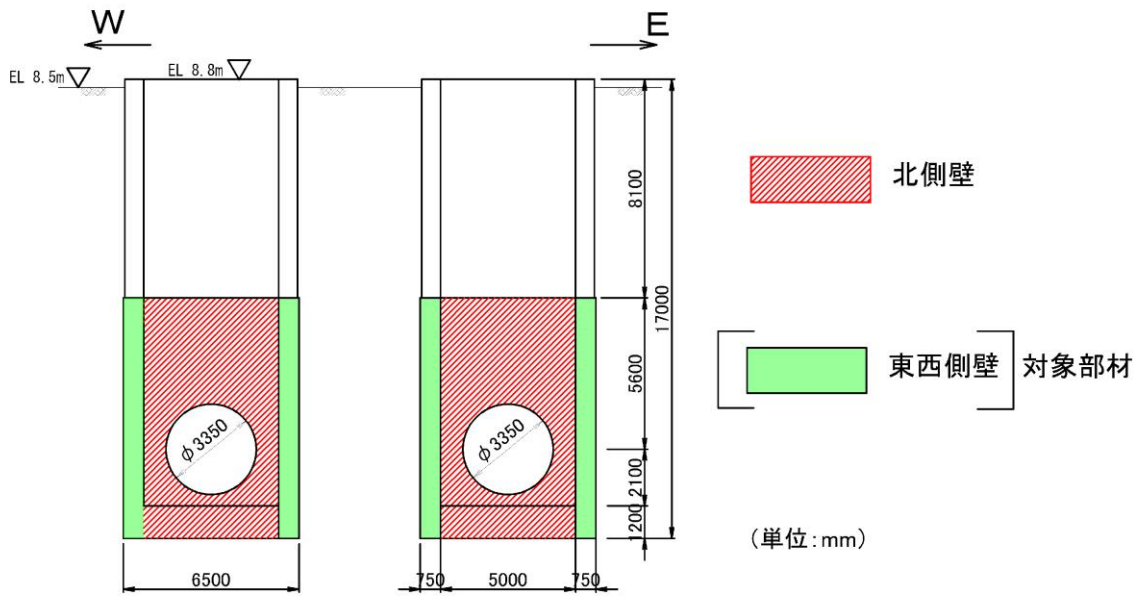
1号機取水槽評価対象部材断面図 (B-B断面)
